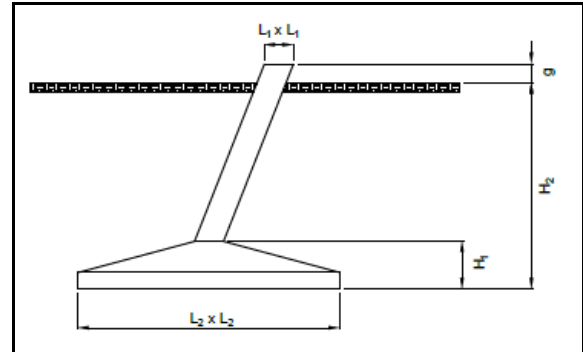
Bloco típico para estaiado de estrutura estaiada
